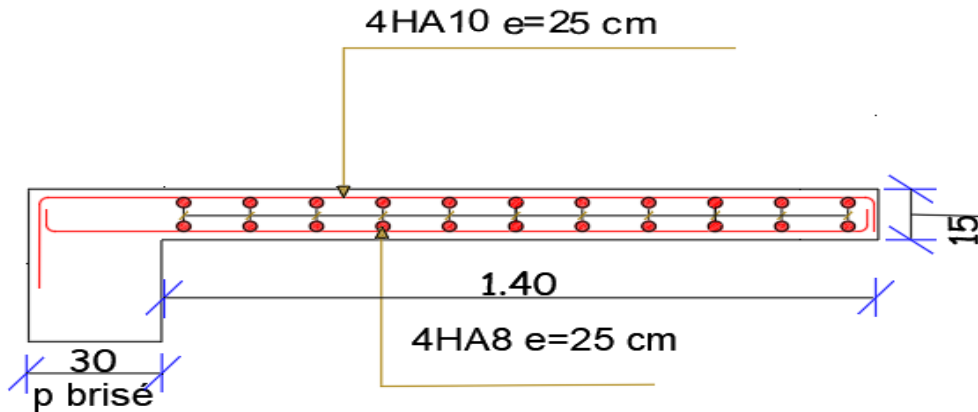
Schéma de ferrailage de l'escalier étage courant.
